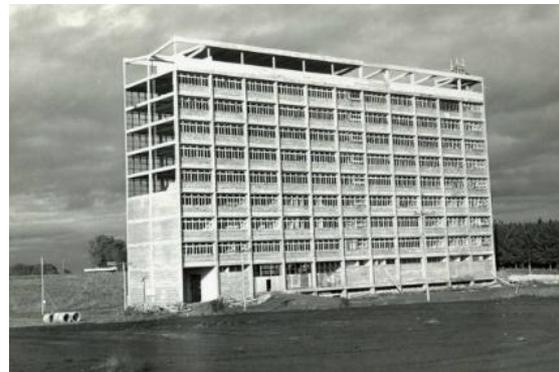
Foto da construção da Reitoria em junho de 1973 (FONTE: PAVEZI, 2010 p. 118).
